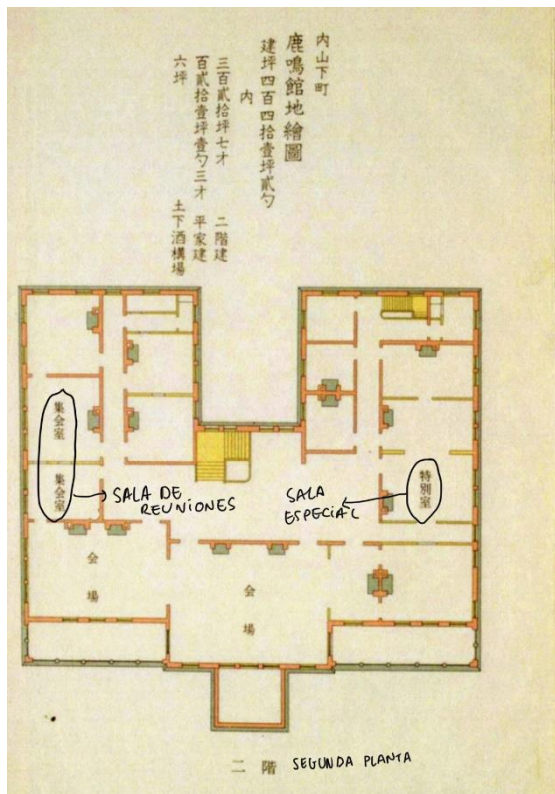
Plano de la segunda planta del Rokumeikan. Traducción: elaboración propia. Acceso en: <https://sakamichi.tokyo/?p=17065>
